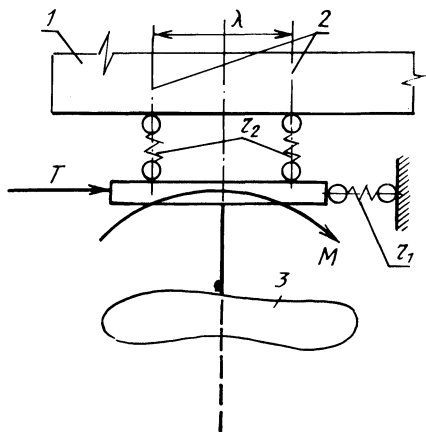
Расчетная схема опирания пролетных строений на опоре: 1 — пролетные строения, 2 — оси опирания, 3 — расчетная поверхность грунта.
